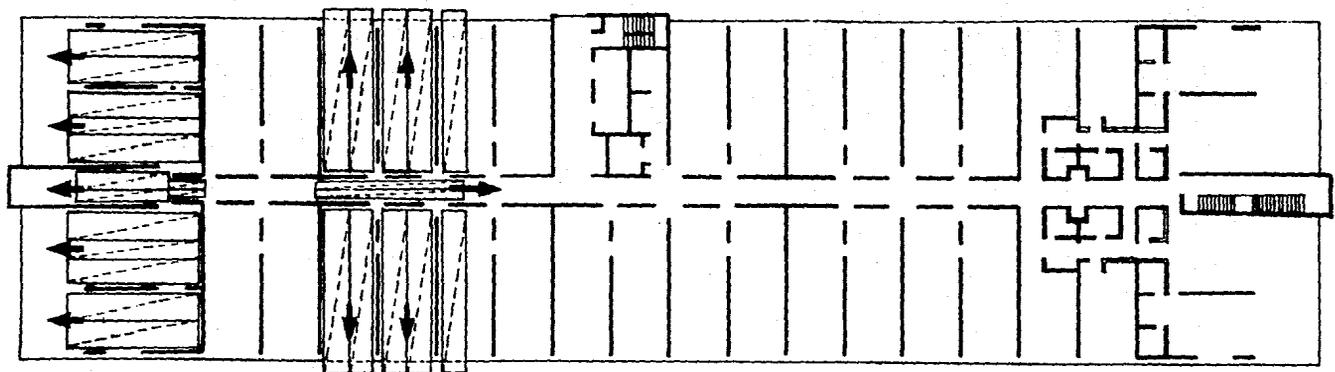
Planta tipo de los condominios construídos en Cancún
